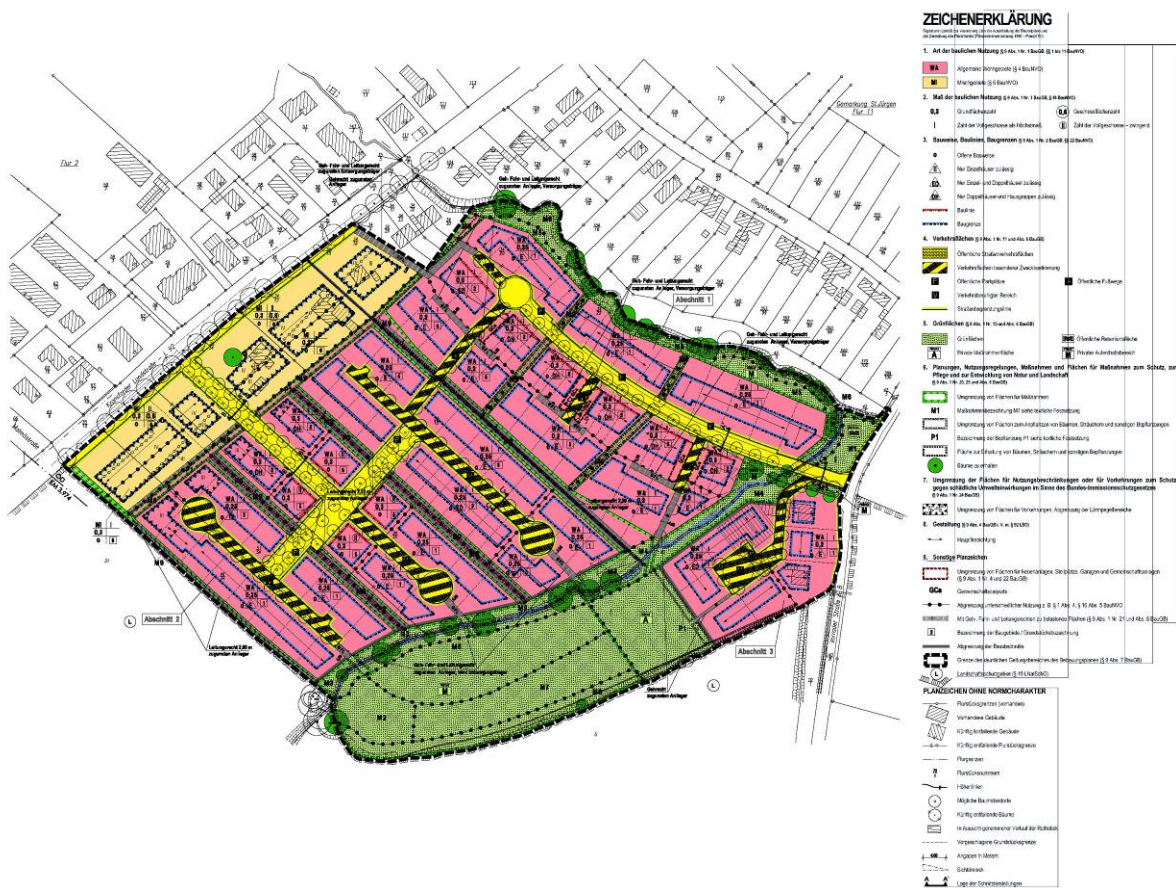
Bebauungsplan 09.16.00 – Kronsforders Landstraße / Vorrader Straße – Rothebek
